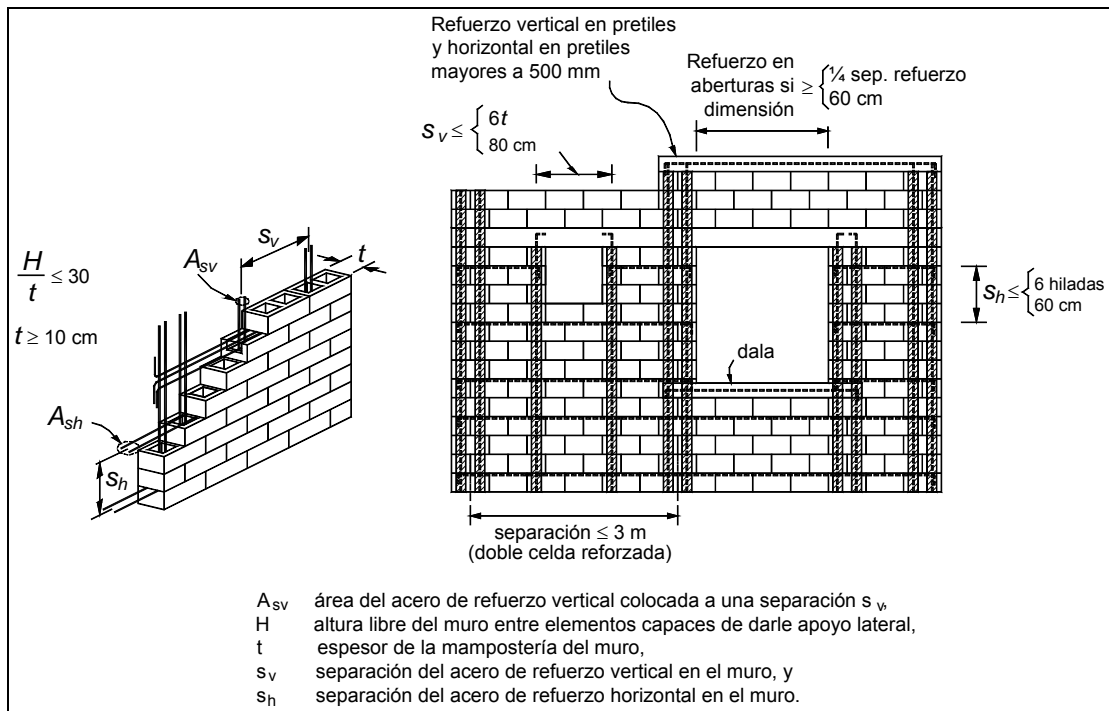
Ejemplo de mampostería de piezas huecas con adecuado refuerzo interior
